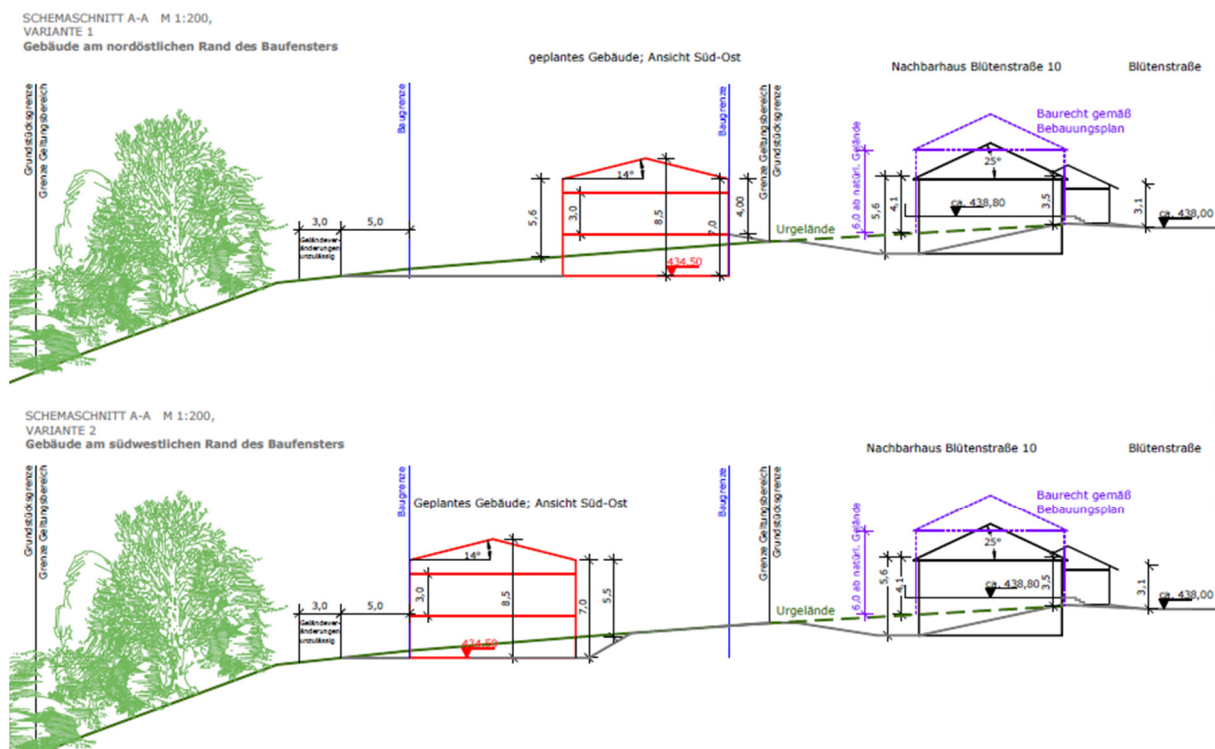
Schemaschnitte A – A, Geländeentwicklung mit möglichen Baukörpern;
